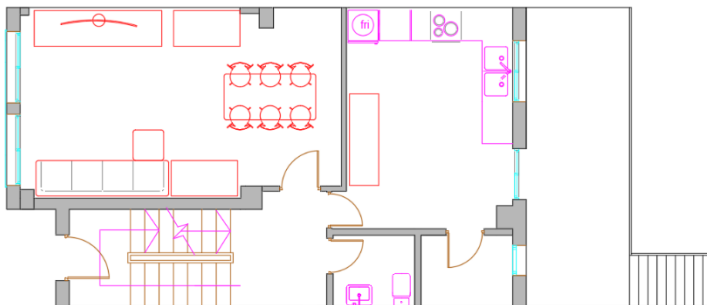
Distribución del estado actual Pl. baja. Fuente propia
